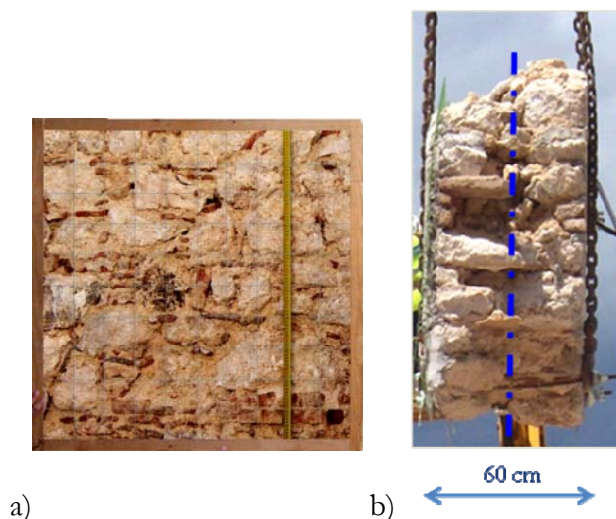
a) Foto facciata prospiciente Via Pretratti con indicazione dei pannelli testati; b) Foto pannello n.5 facciata rivolta su Piazza San Pietro.
